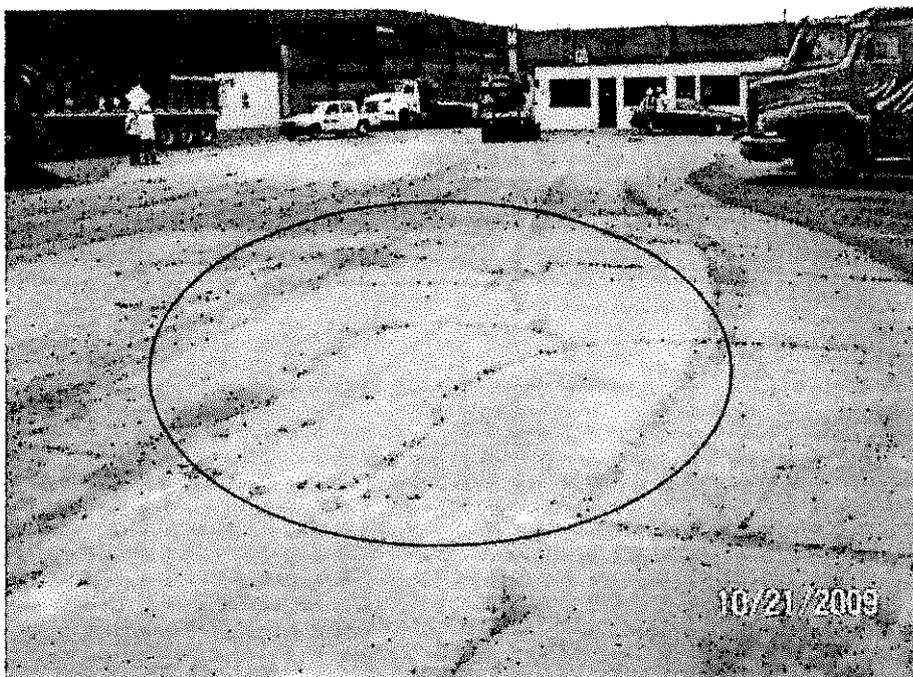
Losa de concreto del lado Norte del depósito de concentrados con rajaduras (Patio 3).
